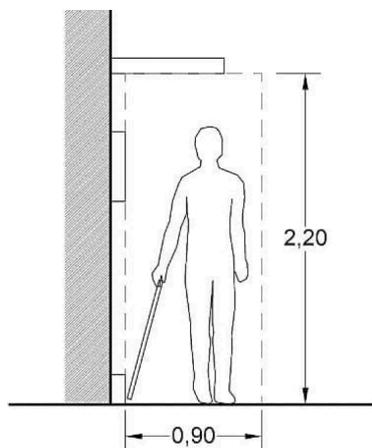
17. Puntos principales a tener en cuenta para facilitar la detección de obstáculos (cotas en metros)
